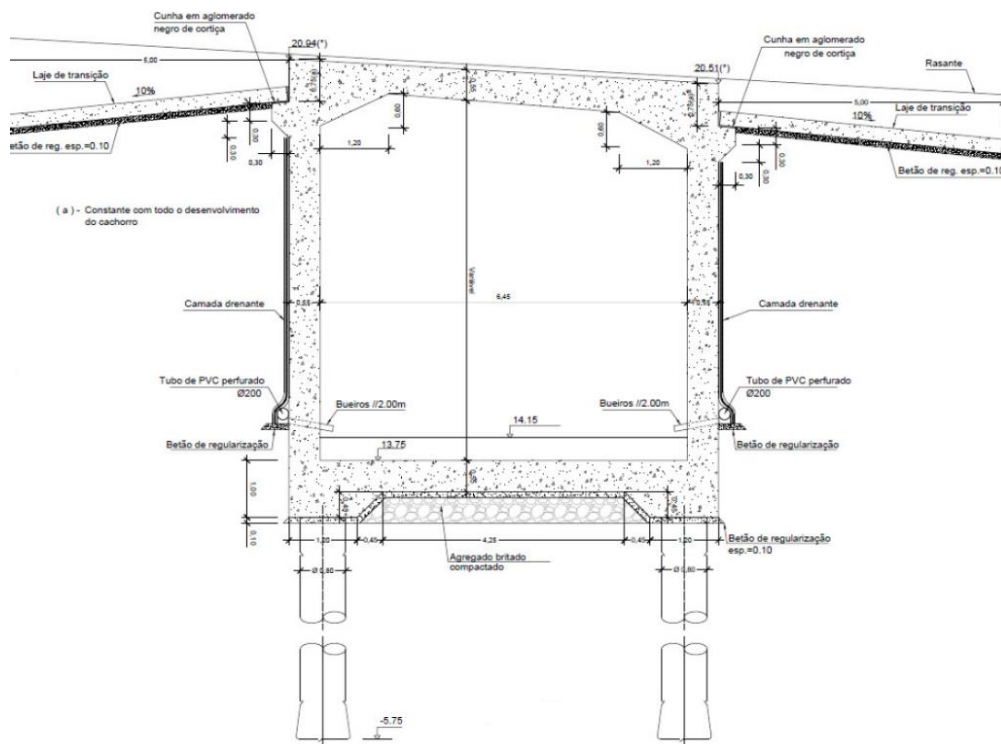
Corte transversal Passagem Inferior Agrícola
